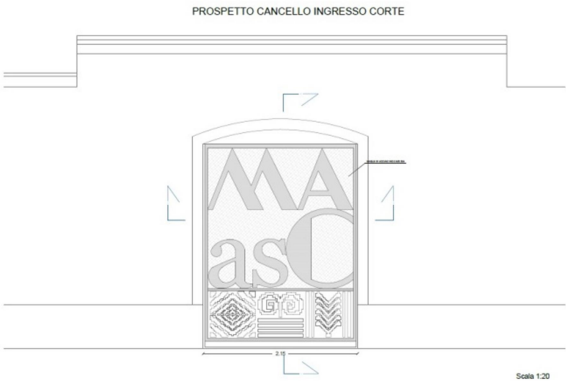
Prospetto cancello ingresso corte – Piazza Corrias
